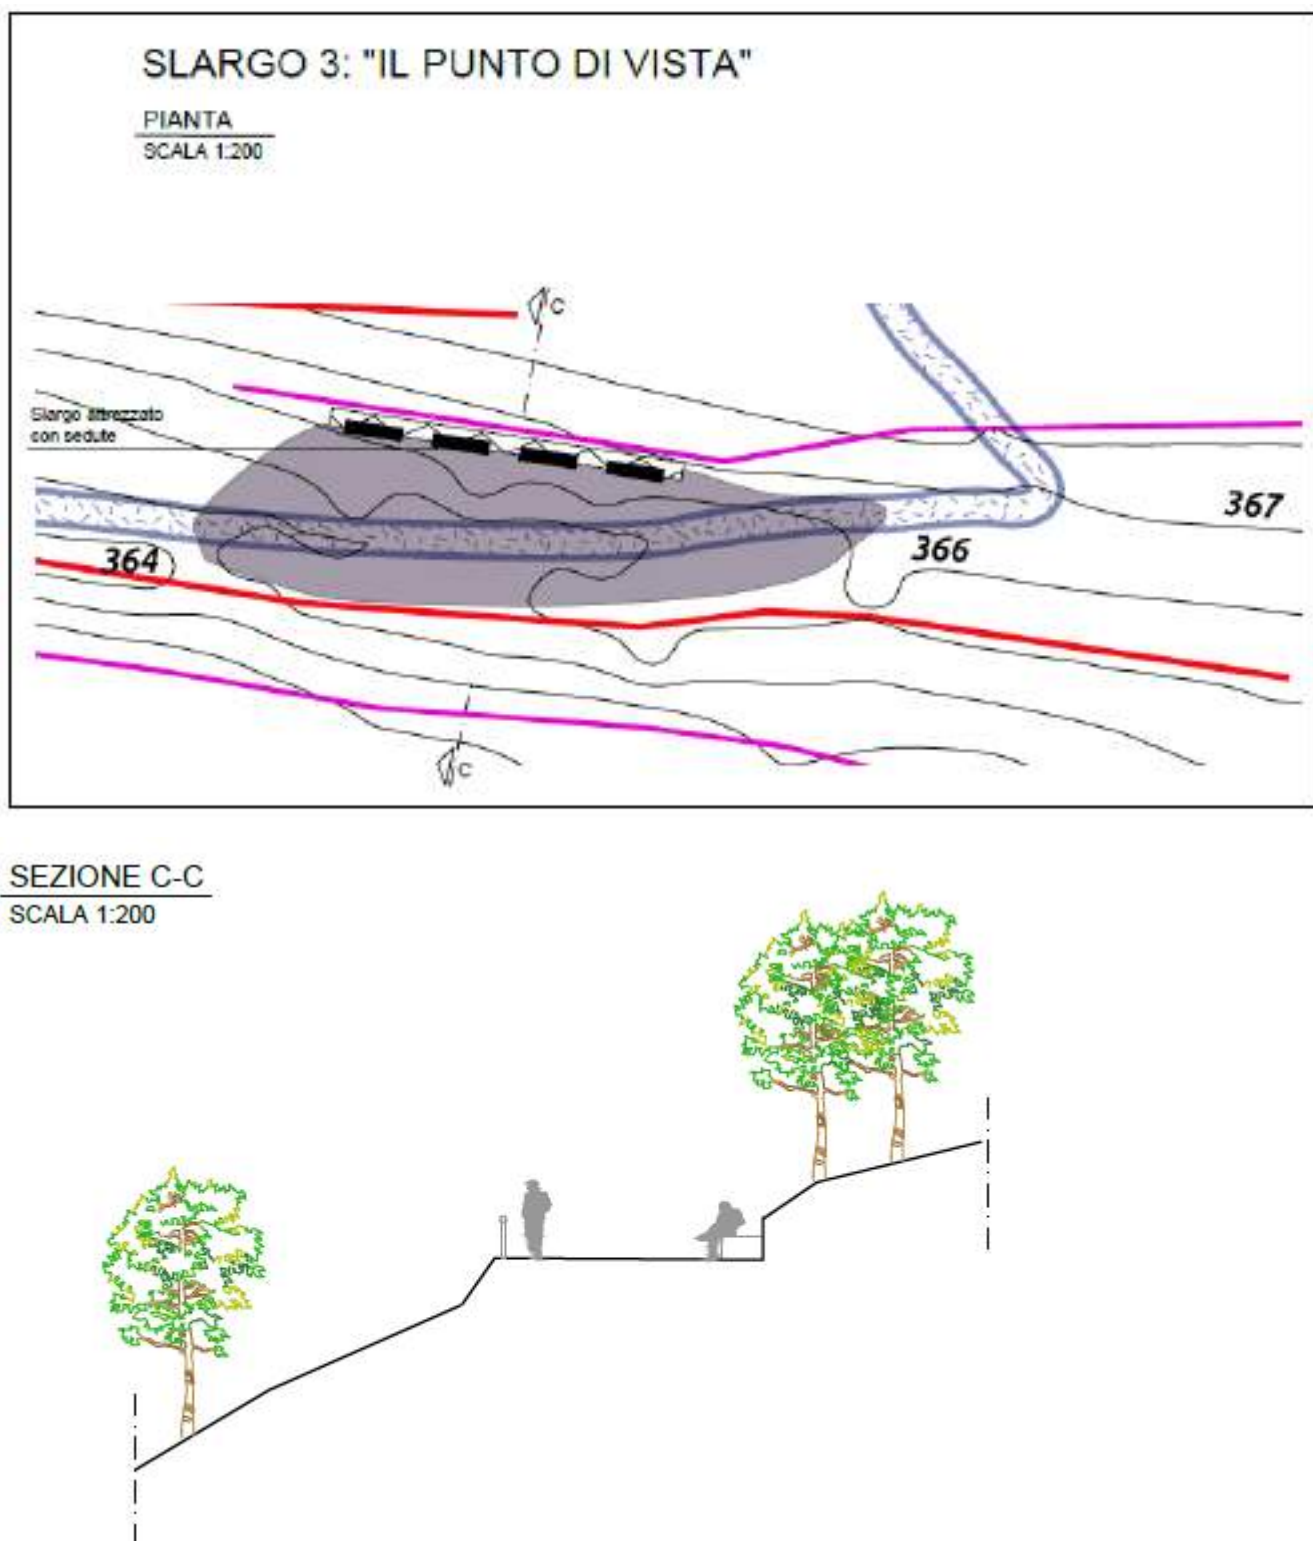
Planimetria e sezioni per lo Slargo 3 "il punto di vista"
